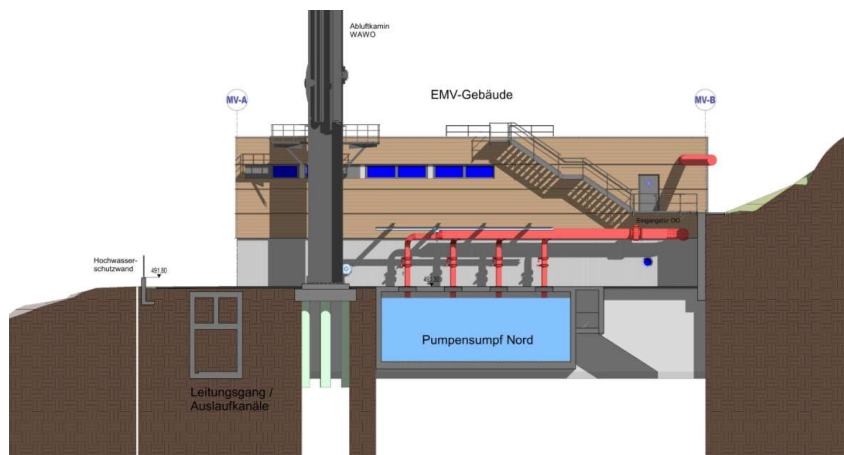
Fassaden Projektplan 1:100, Neubau Elimination Mikroverunreinigungen (Süd-Fassade), Hunziker Betatech AG, 04.09.2023
